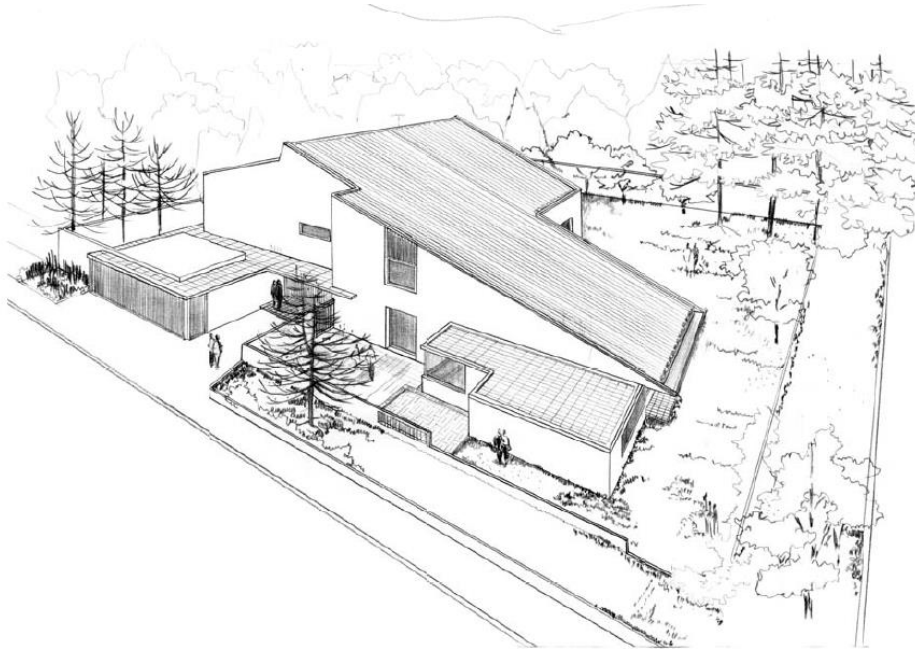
Axonometría del proyecto Casa Gómez. Fuente: Archivo IDPC
